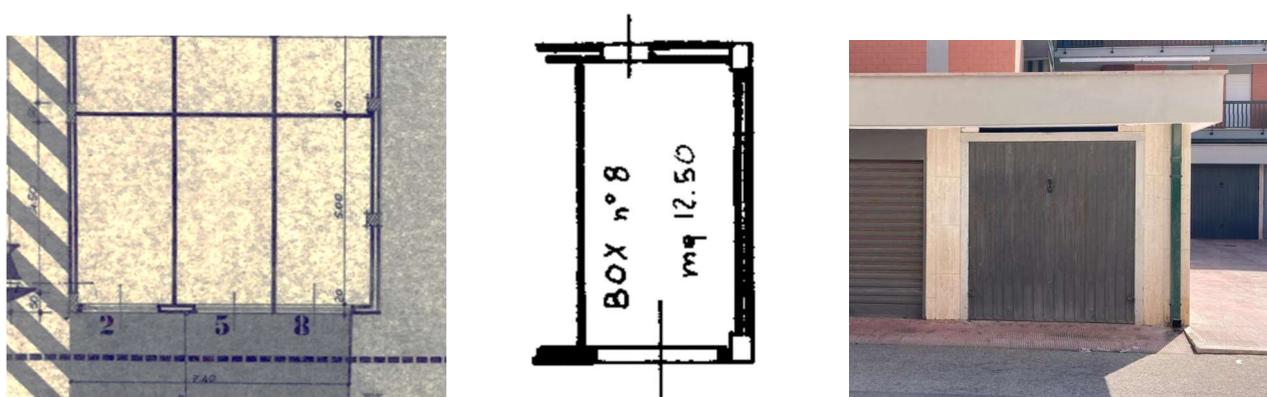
Accostamento tra planimetria progettuale (sinistra) e lo stato dei luoghi (destra, foto del sopralluogo)
